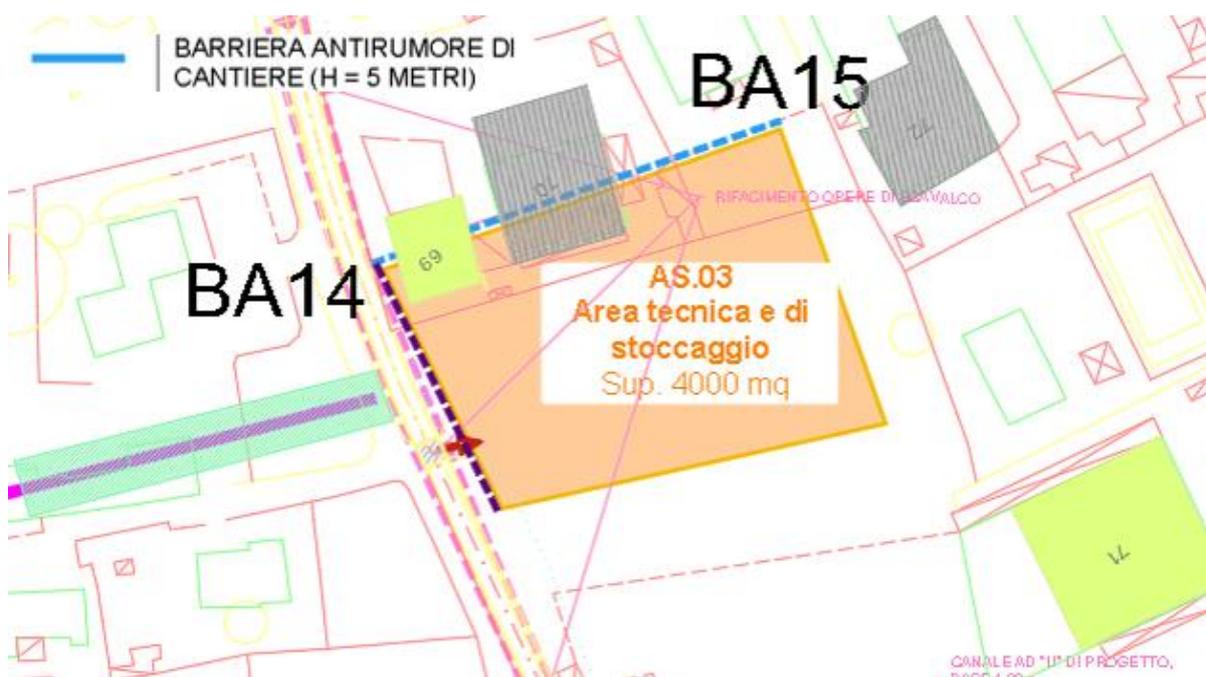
AS.03 Ubicazione planimetrica della barriera antirumore/antipolvere di cantiere
